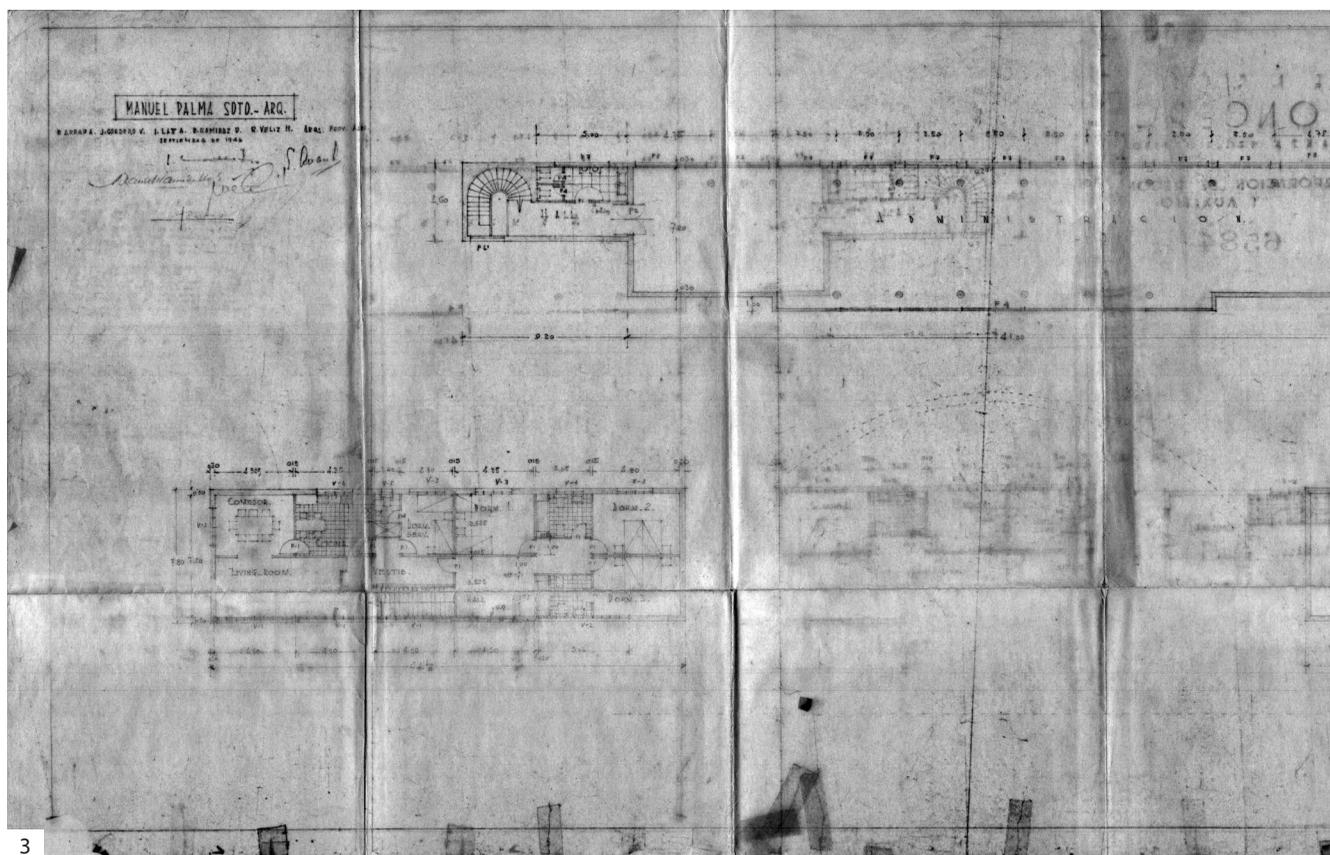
Planta de segundo piso del Mercado Central de Concepción, a escala 1:100, septiembre de 1946. Autor: Corporación de Reconstrucción y Auxilio. Fuente: Dirección de Obras Municipales de Concepción / Figura 4 Proyecto de alcantarillado para el Mercado Central de Concepción, agosto de 1947. Autor: Corporación de Reconstrucción y Auxilio. Fuente: Dirección de Obras Municipales de Concepción.
